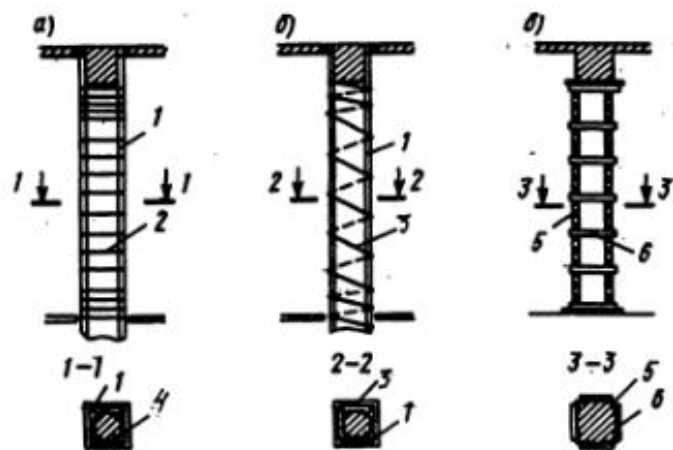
Усиление колонн и столбов: а – железобетонной облоймой; б – то же спиральной арматурой; в – стальной облоймой; 1 – вертикальная арматура; 2 – хомуты; 3 – спиральная арматура; 4 – колонна; 5 – стальные уголки; 6 – хомуты из полосовой стали
